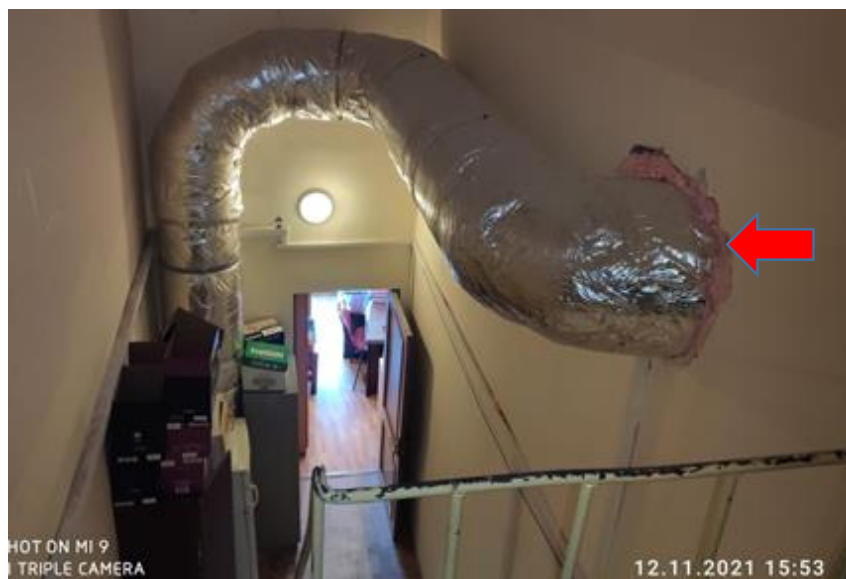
Узел прохода вентиляционная система Вн 2 через стену выполнен не в соответствии с проектным решением (не через гильзу)
